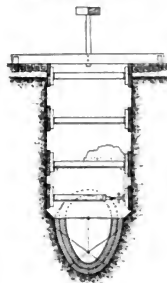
Kanal aus Mauerwerk in festem Boden.
